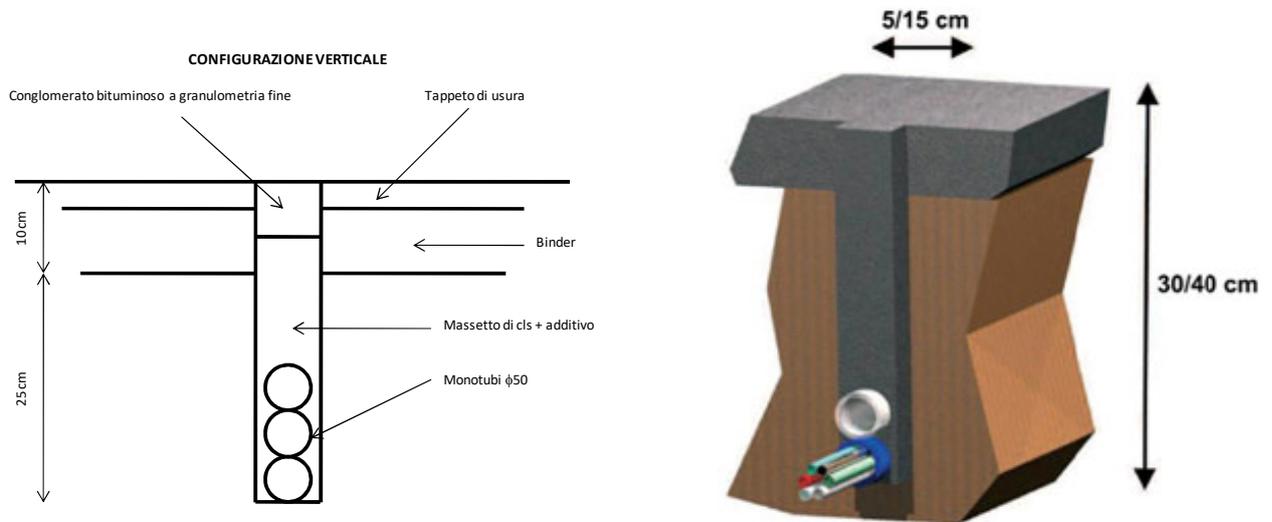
Sezione tipo scavo in trincea su sede stradale
